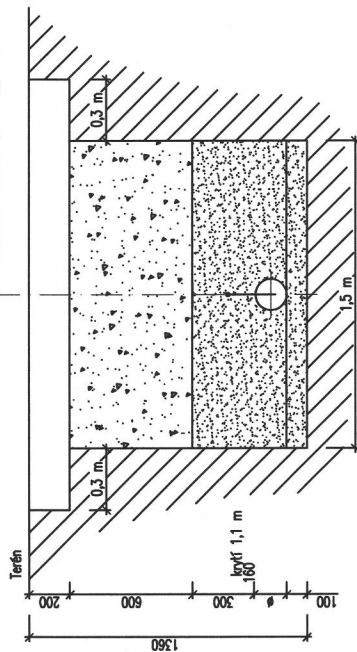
# DETAIL ULOŽENÍ POTRUBÍ M 1:25
